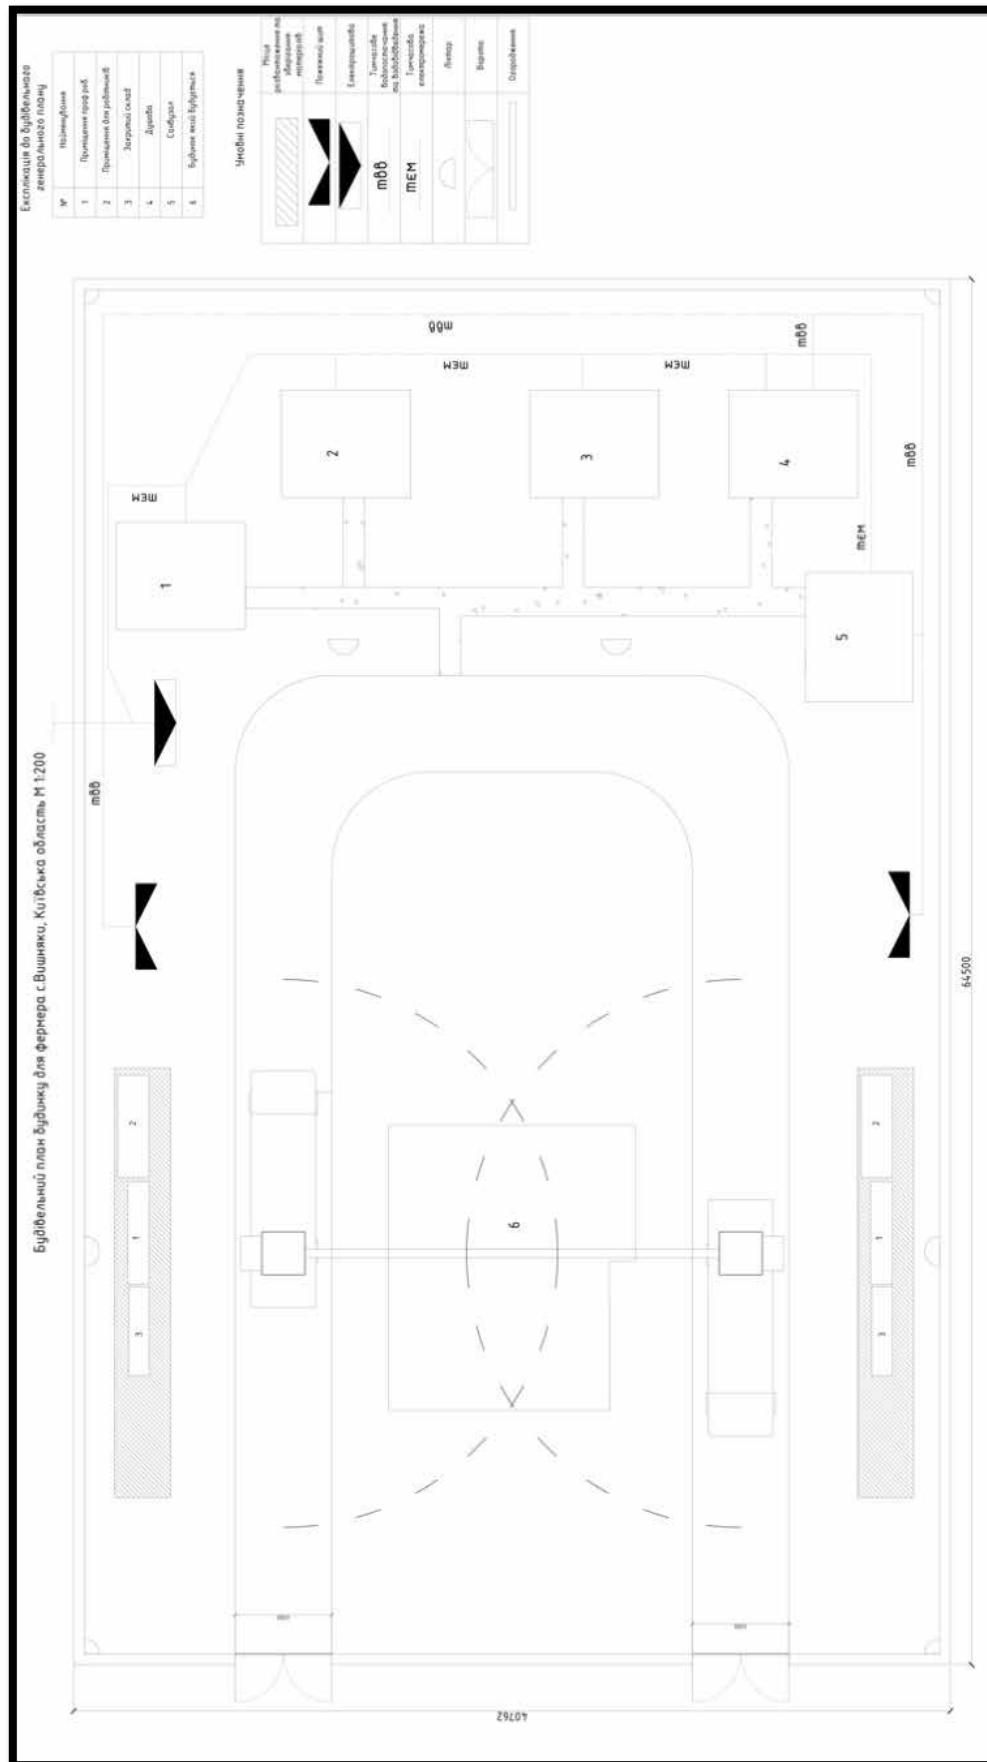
Будівельний план будинку для фермера у с. Вишняки, Київської області.
